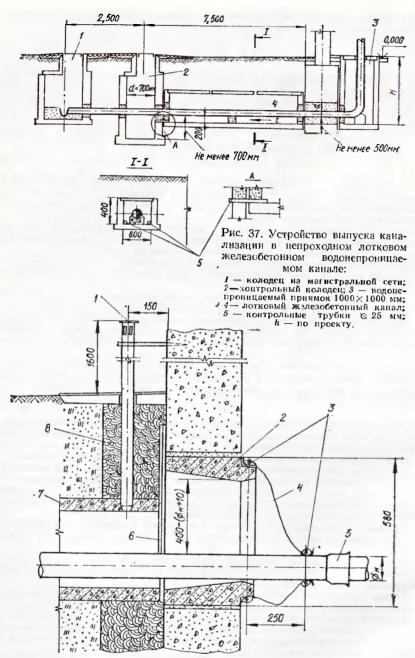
Выпуск канализации из здания, сооруженного на прогадочных огрунтах:
